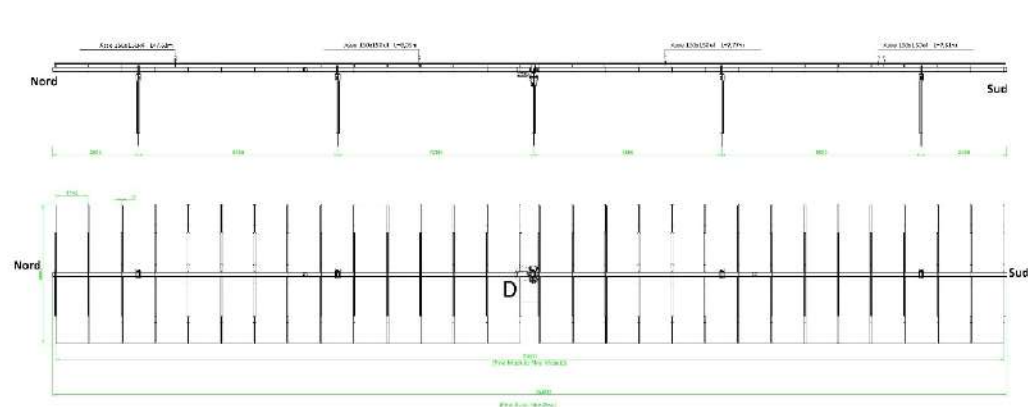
Particolare vista in sezione e in planimetria delle strutture
